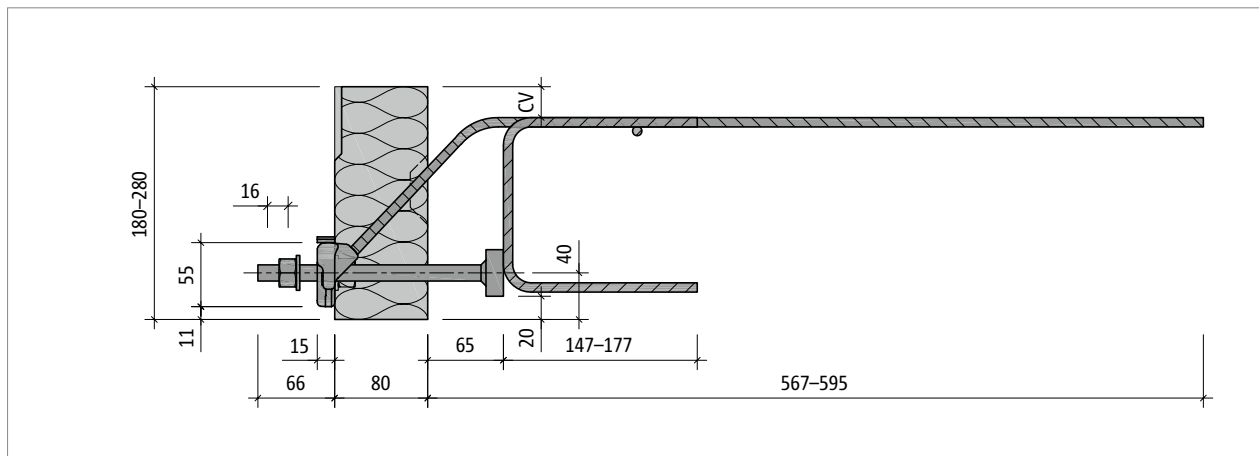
Schöck Isokorb® T type SQ-V1 : coupe du produit
